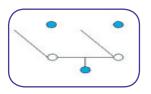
مخطط تفصيلي لتوصيل مصباح مع مفتاح مفرد
